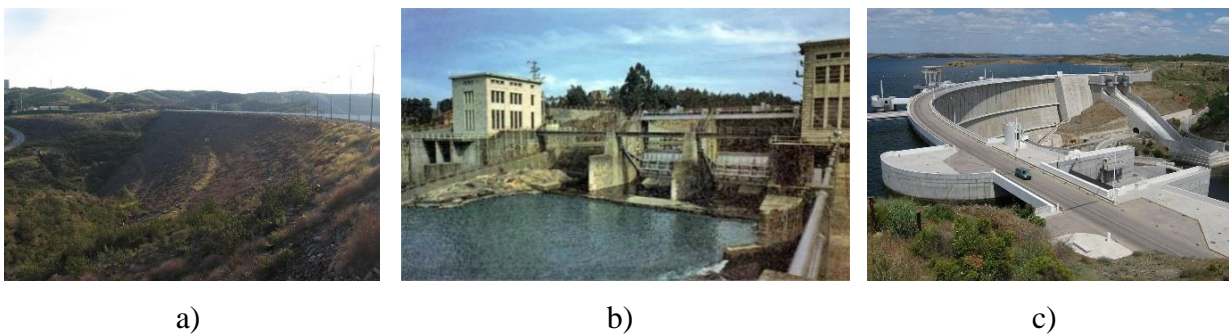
a) Barragem do Beliche (Tipo Aterro); b) Barragem de Penide (Tipo Alvenaria); c) Barragem do Alqueva (Tipo Betão) (Wikipédia, 2014) (Instituto da Água, 2014).
